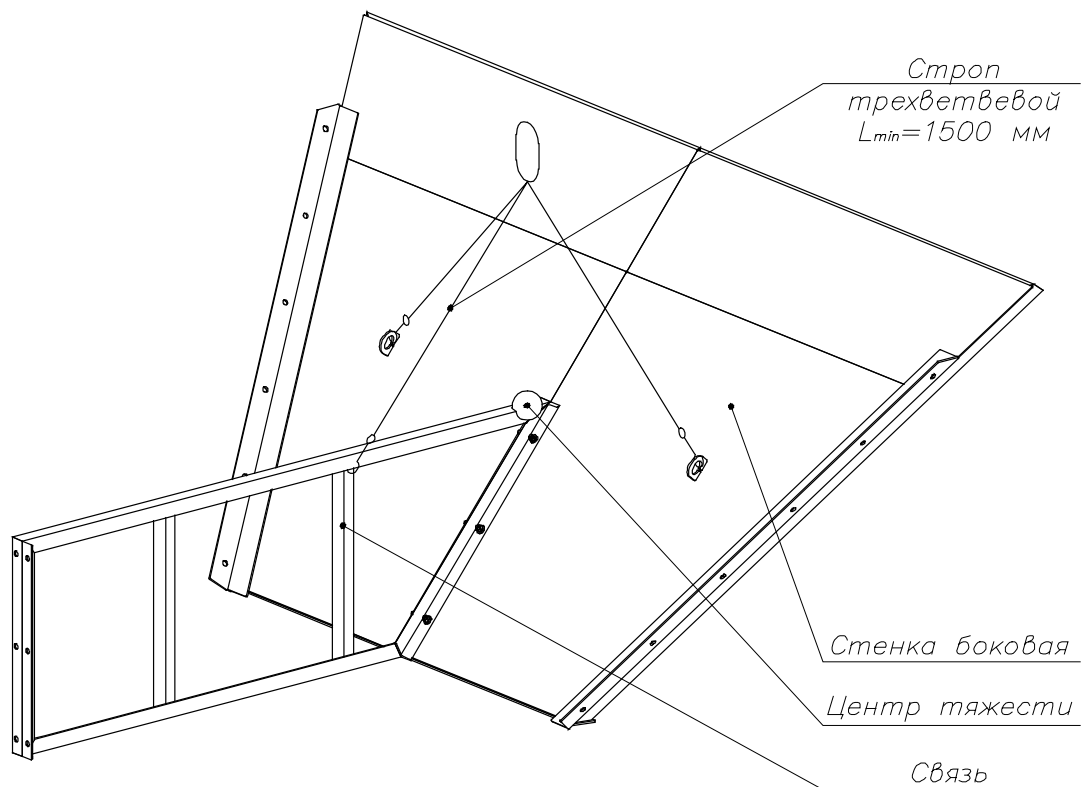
Схема строповки боковой стенки в сборе со связью.
